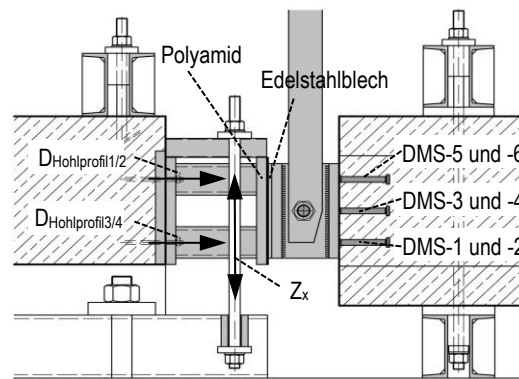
Fixierung der Ankerplatte mit Druckstempel
